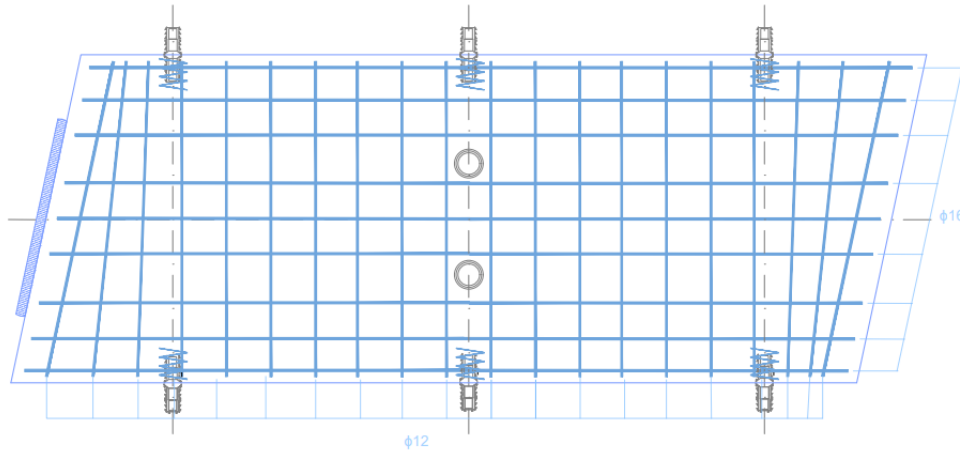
Plano Dovela – Armadura Vista Inferior
